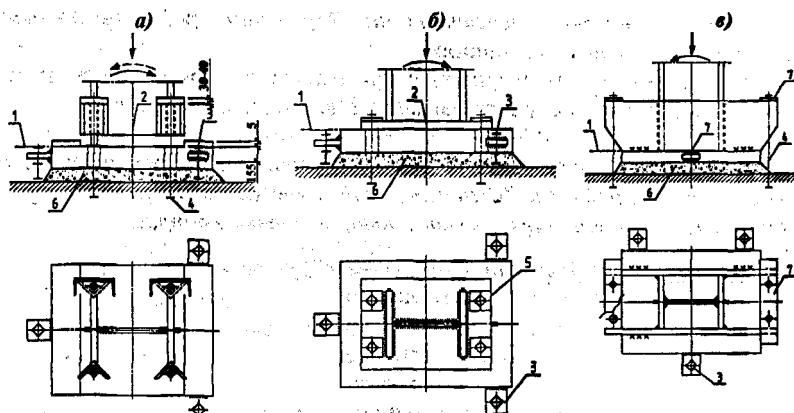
Базы колонн с расчетными анкерными болтами:
